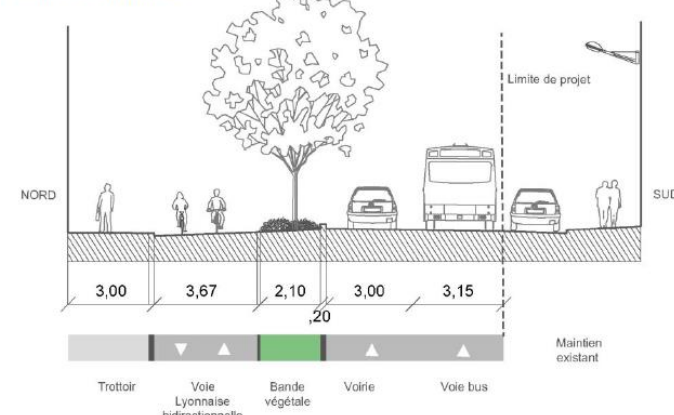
Coupes de l'existant et du projet rue de Bonnel, Section 1 : Corneille – Avenue de Saxe
